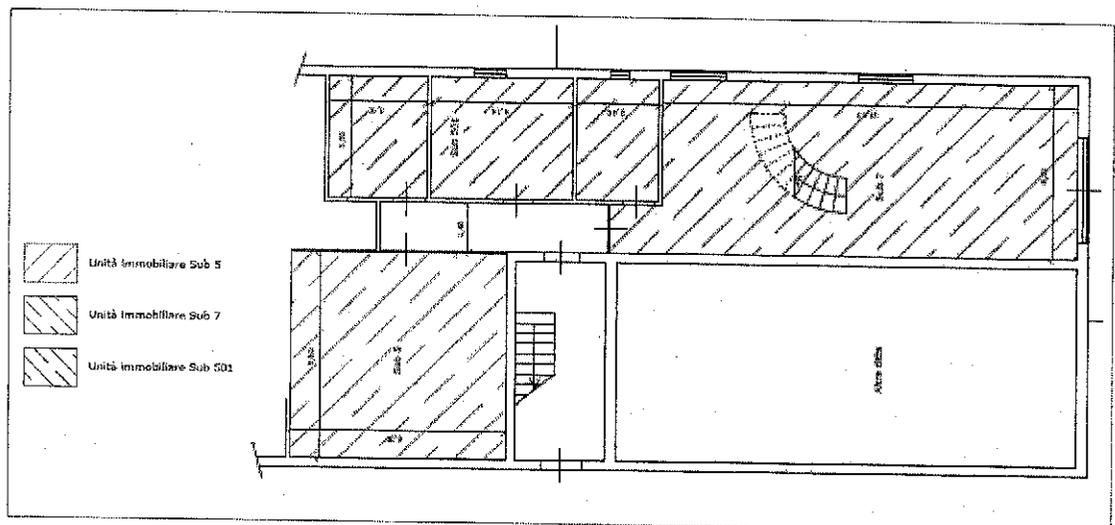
Pianta piano seminterrato estratta dalla precedente Perizia con indicazione dei sub in trattaggio colorato
